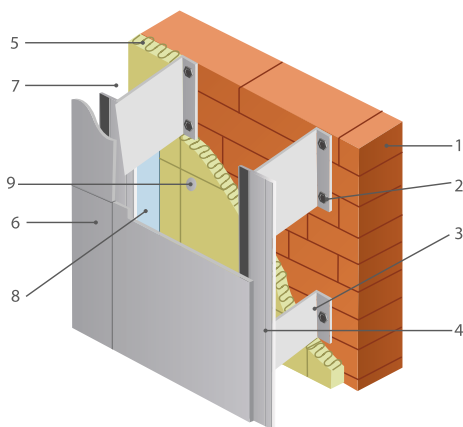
Конструкция навесного фасада с воздушным зазором:
